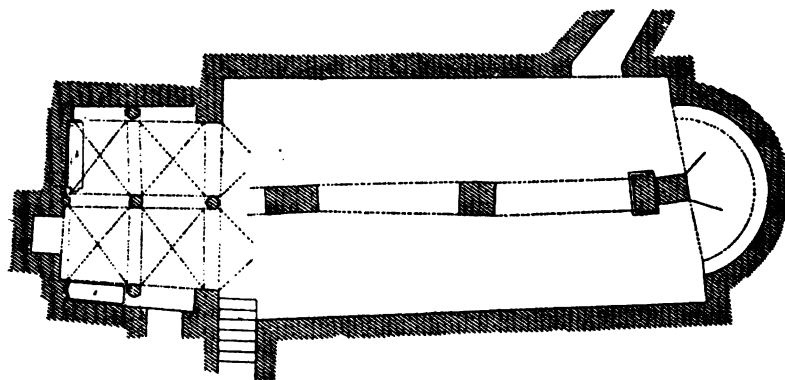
Grundriss der Unterkirche in Andria.
